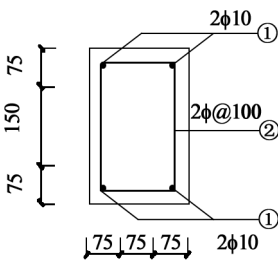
钢筋混凝土梁截面配筋图(单位:mm)
